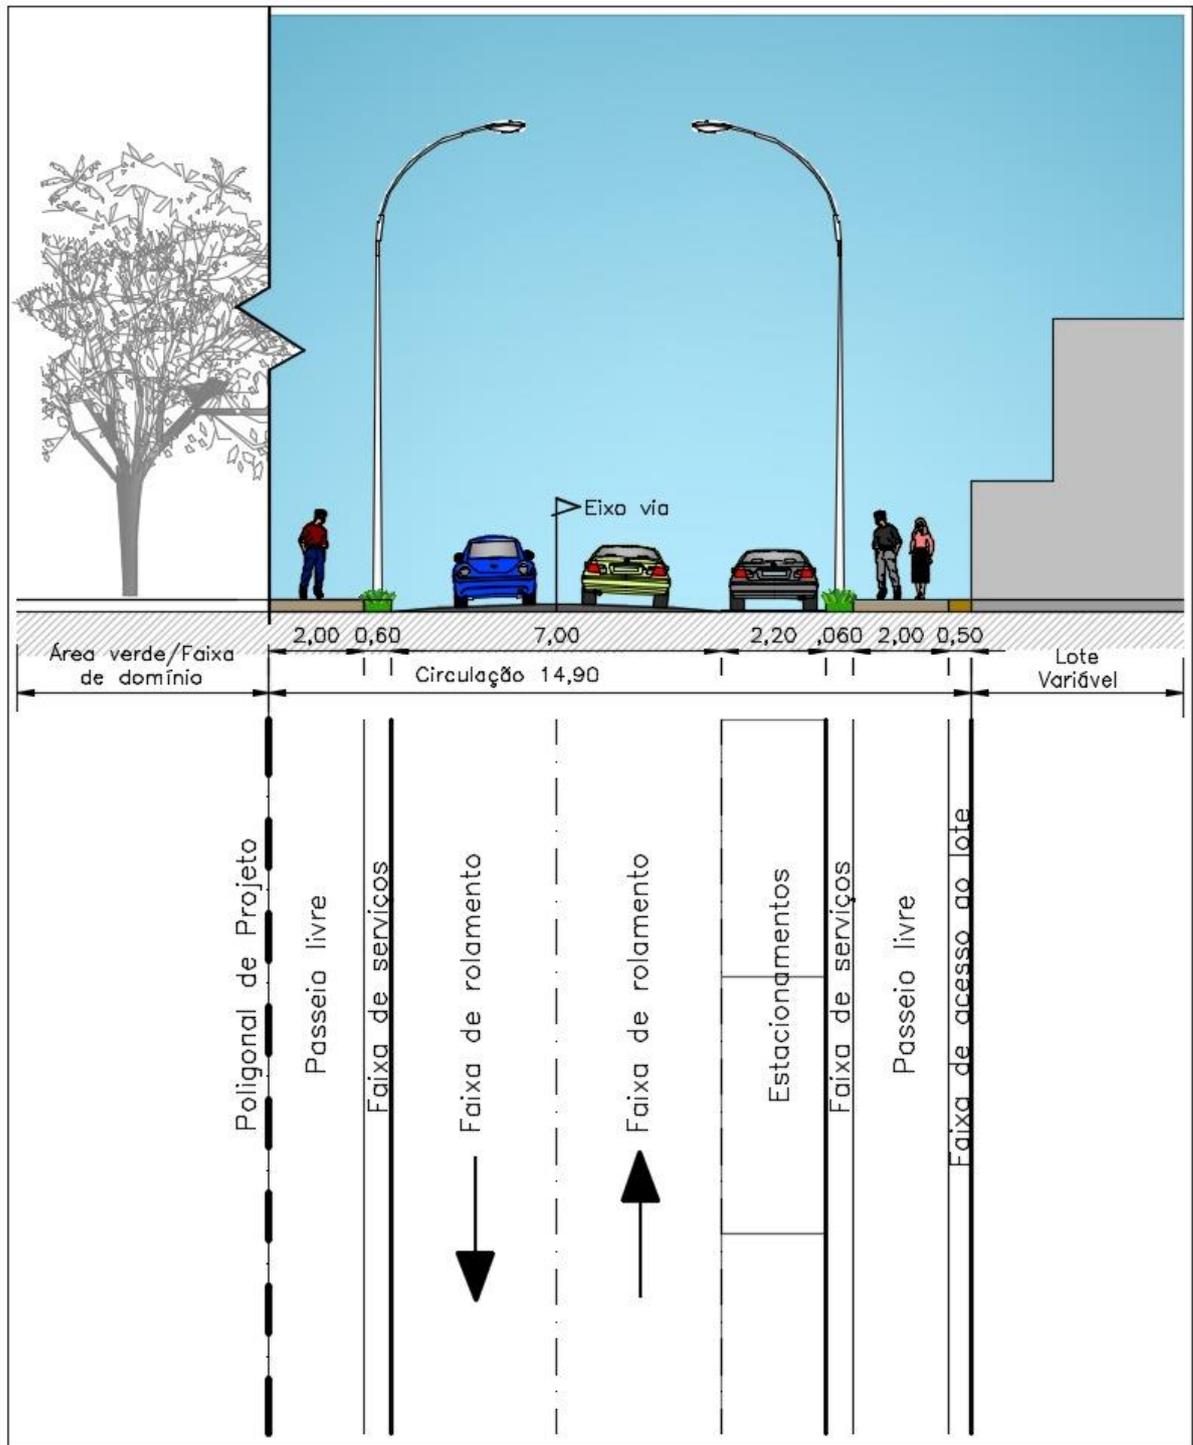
Perfil 08 - Via de Circulação de Vizinhança 2 – Zona 30 (margeia a DF 290)
